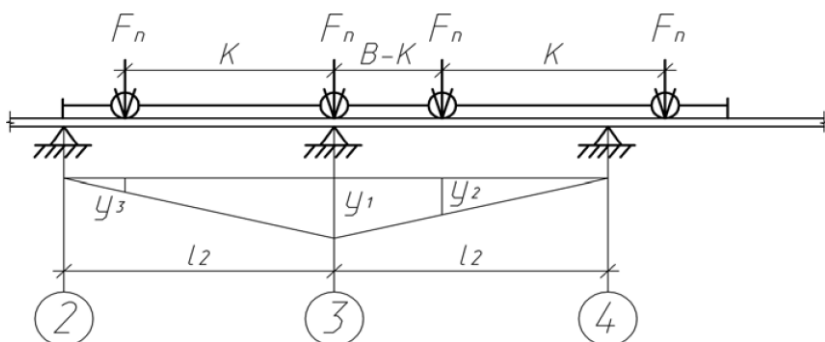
Розрахункова схема до визначення кранового навантаження.
